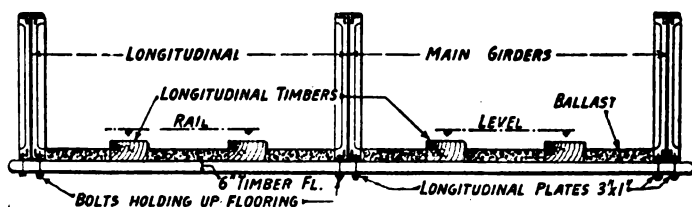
Sezione trasversale del pavimento originale, su travi di legno.
